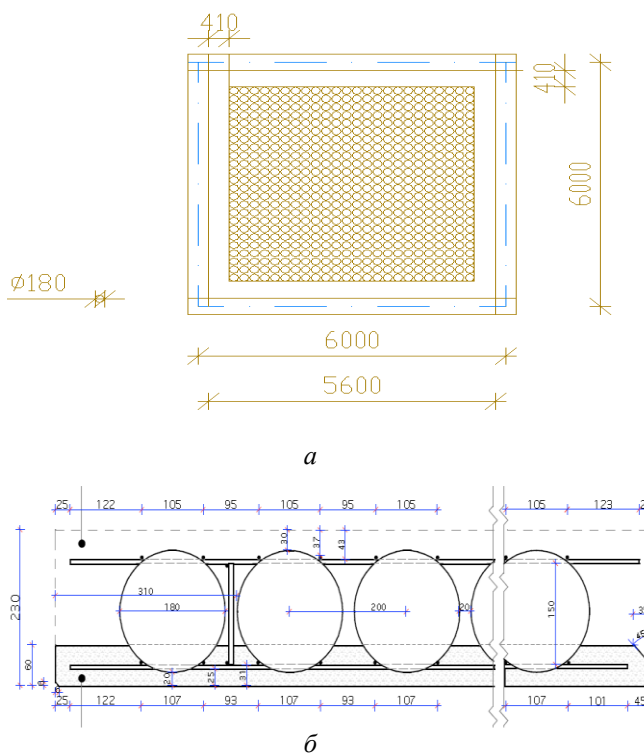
Конструктивна схема плити перекриття з пустотами з пластиковими кулями:
